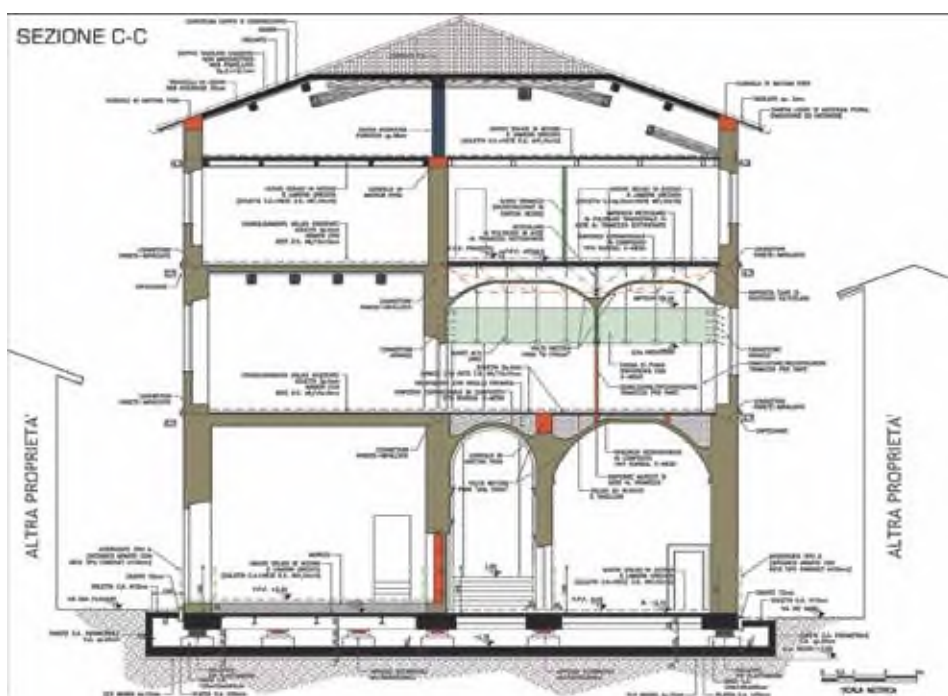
Sezione trasversale tipo dell'edificio isolato
